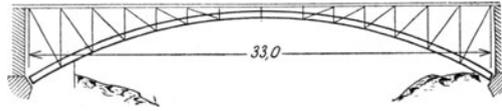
Brückenartiges Montagegerüst für ein eisernes Walzenwehr über den Arc in Savoyen.
